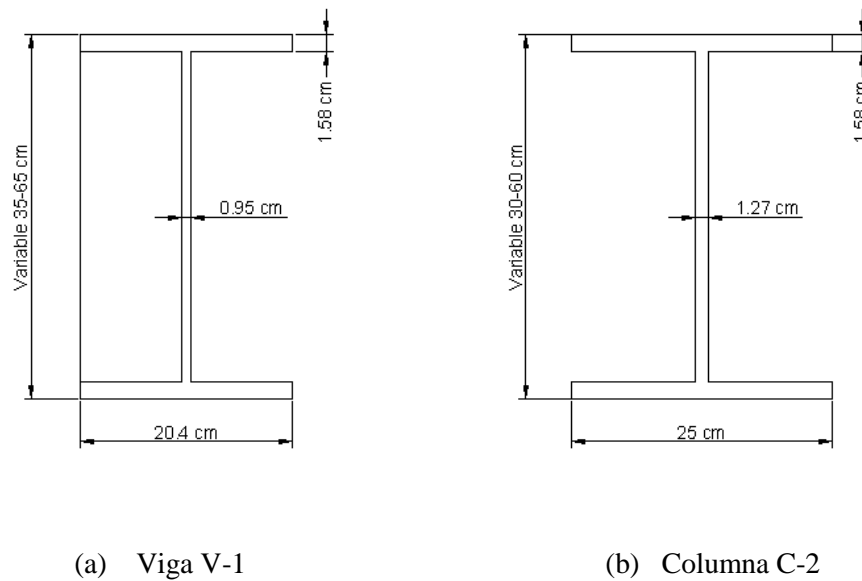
Perfiles estructurales de sección variable del puente peatonal tipo
